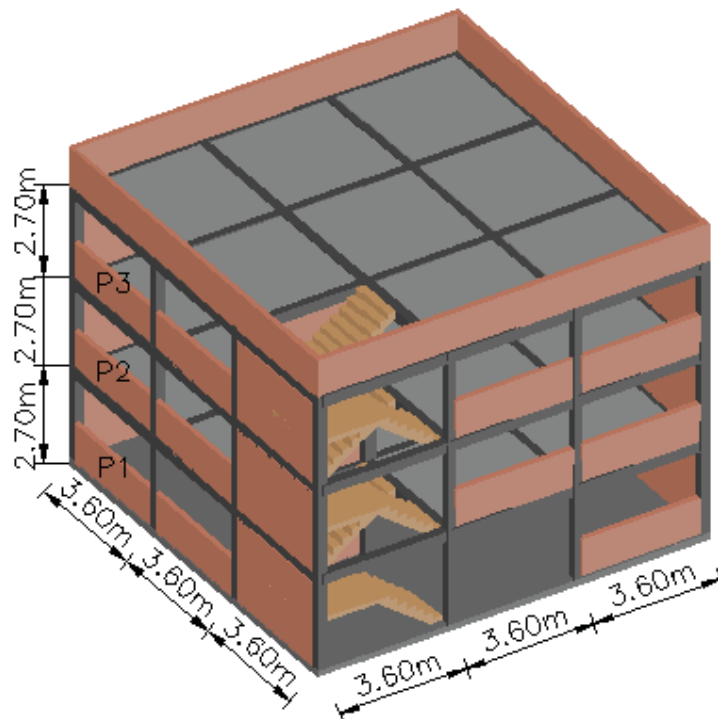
Dimensiones de la estructura (Ejemplo de aplicación)
